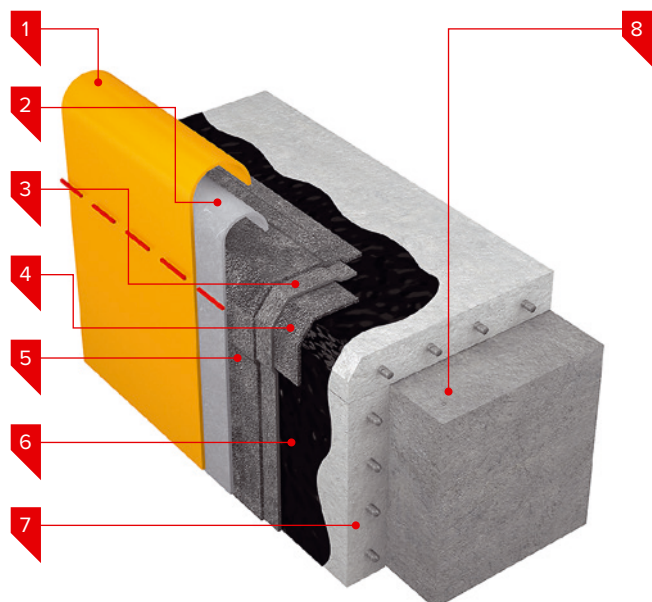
Техноэласт Фундамент. Смена направления укладки материала в цокольной зоне
